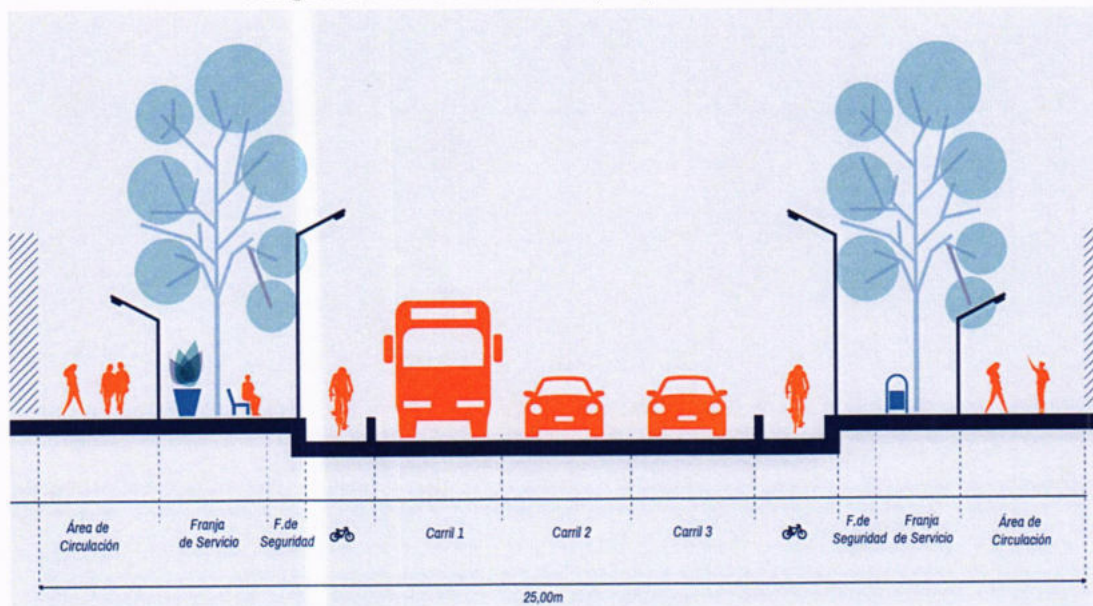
Vía transversal 5 (VT5) del Plan Villanueva Fase 2A
